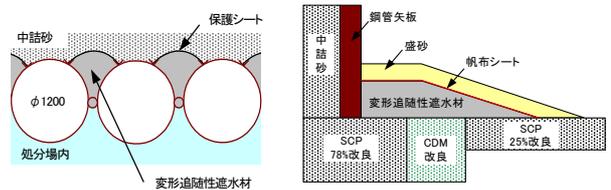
側面遮水構造平面 図-9 底面遮水構造断面
